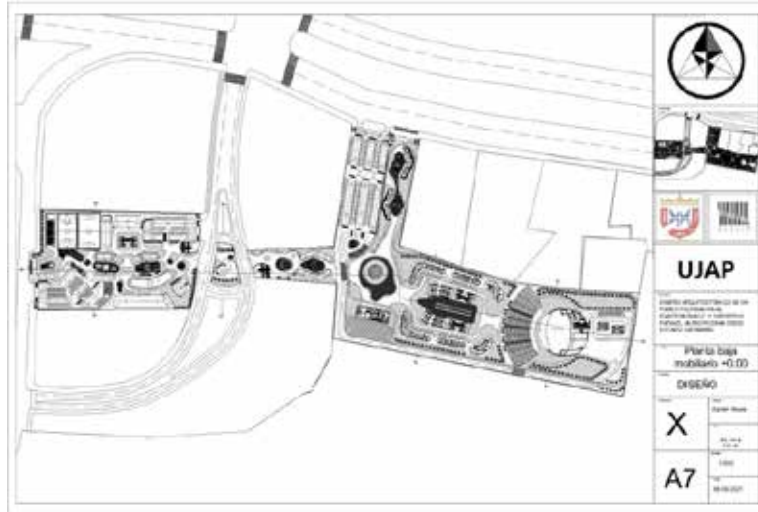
Planta baja nivel ± 0.15 (técnica). El autor (2021)
